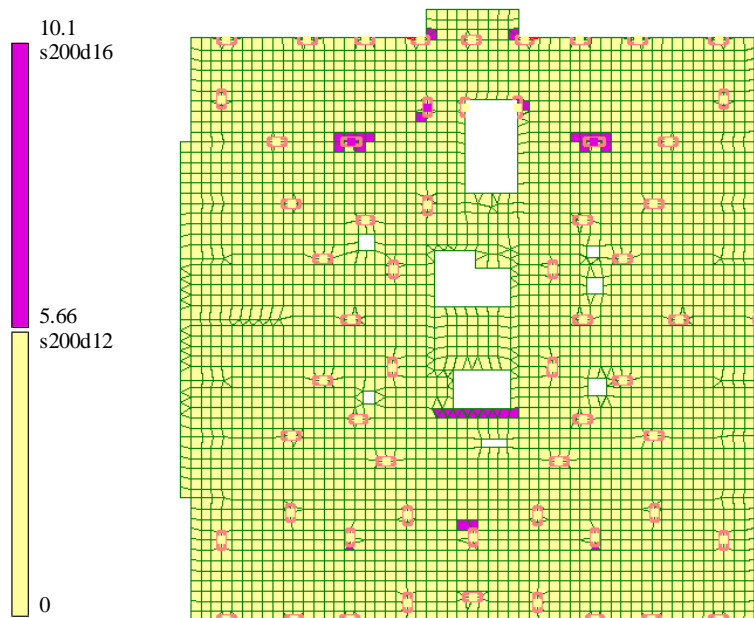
Площадь арматуры на 1 п.м. по оси Y у верхней грани
